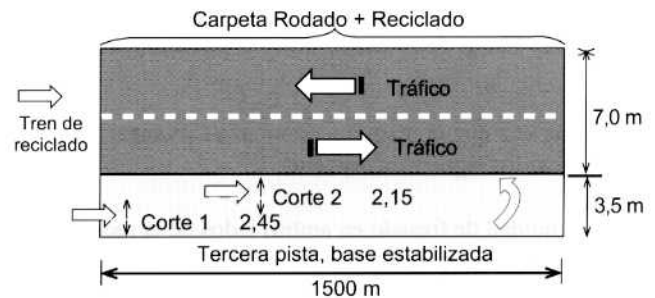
Secuencia del tren de reciclado en pista de adelantamiento, vista en planta
